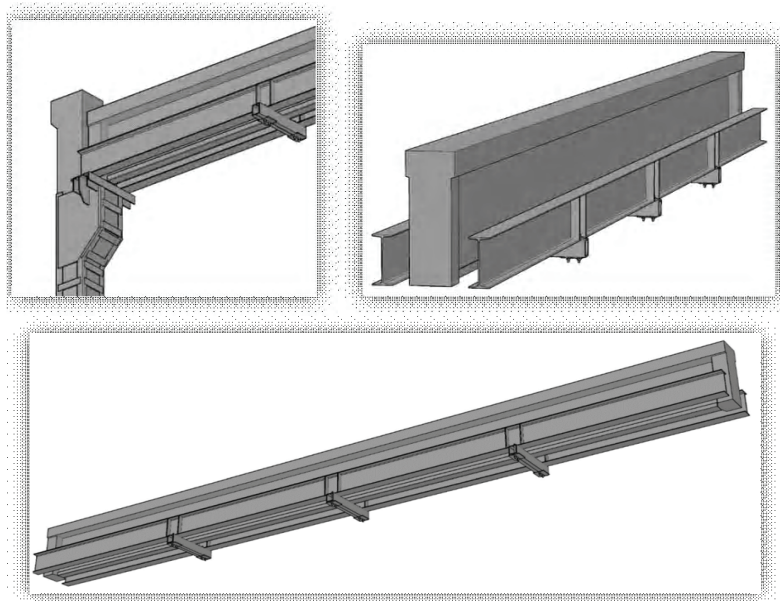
Усиление железобетонной балки подведением металлических разгружающих двутавров.
